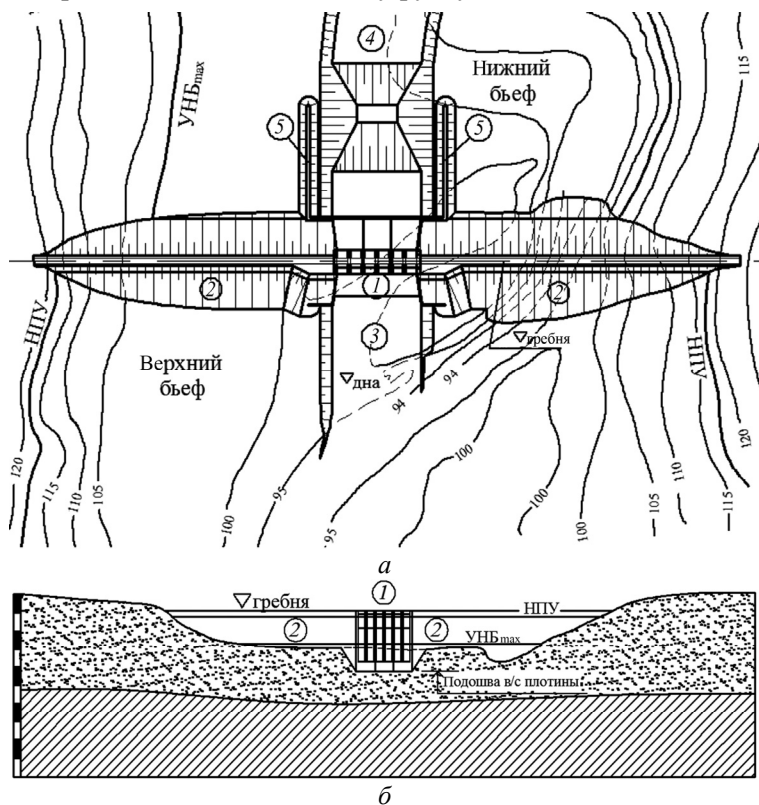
Пойменная компоновка гидроузла: *а* — генплан; *б* — разрез по створу; 1 — бетонная водосливная плотина; 2 — грунтовая (земляная) плотина; 3 — подводный канал к бетонной водосливной плотине; 4 — отводящий канал; 5 — струенаправляющая дамба
